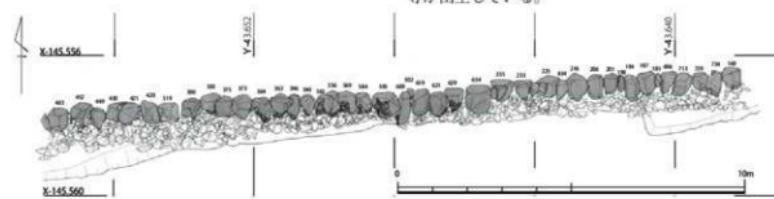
OSJ90-1区 三ノ丸石垣の施工面での平面図
